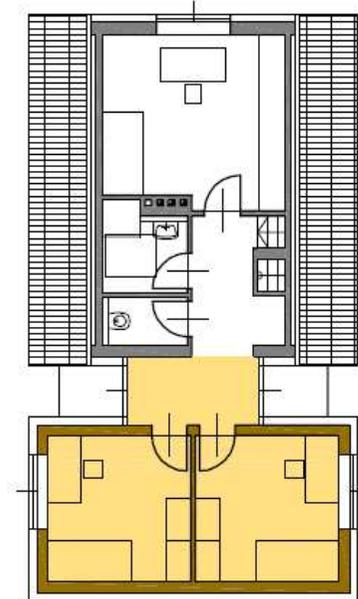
Variante II - Grundrisse⁸⁶
